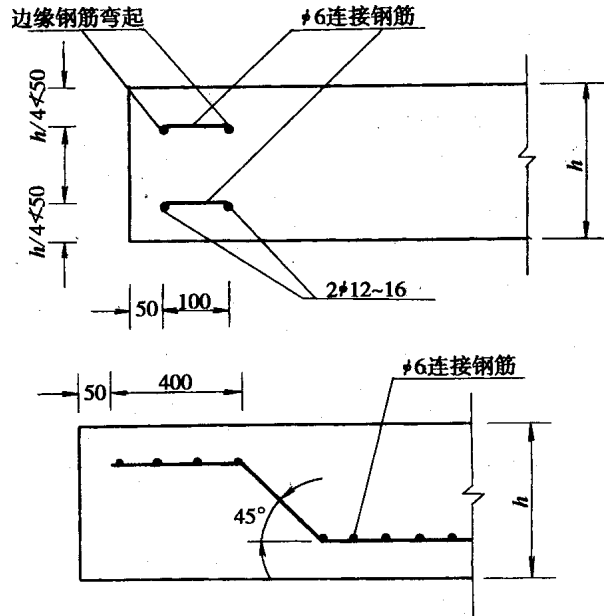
边缘钢筋布置(尺寸单位:mm)
